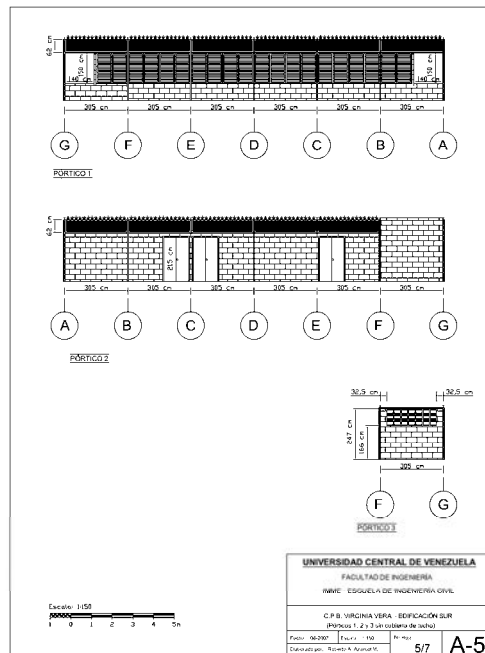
Plano A5: Plano Arquitectónico de los pórticos 1, 2 y 3 sin techo
